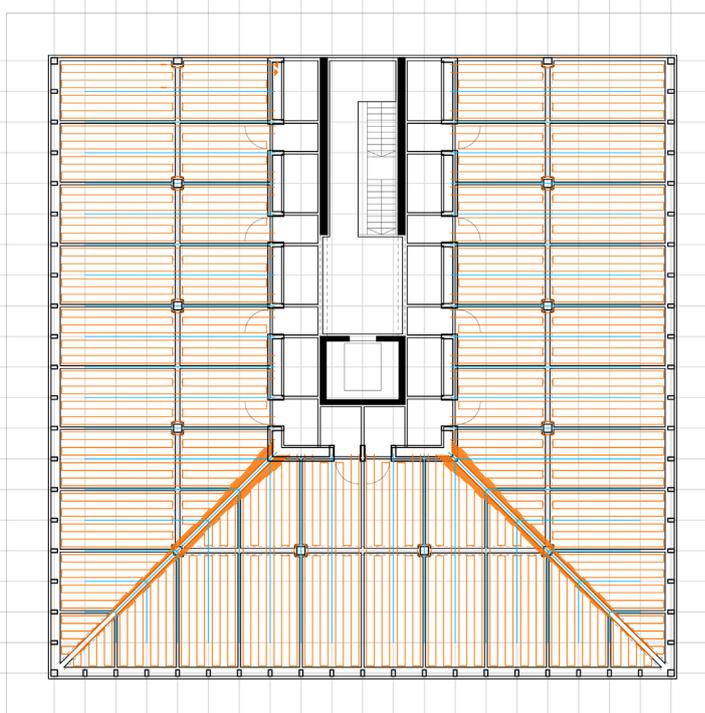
Übersicht horizontaler Leitungsverzug Deckentemperierung und Sprinklerleitungen
